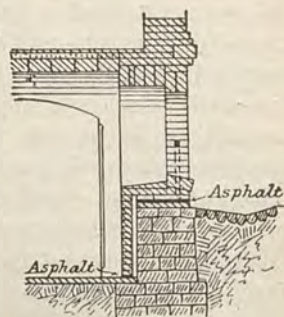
Protezione dei muri da cantina contro l'umidità.
